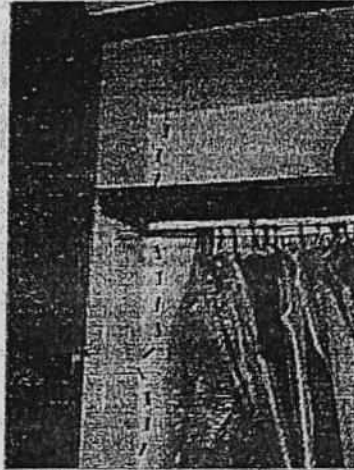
Estado actual de fisura en muro de chimenea apartamento 503 torre costado sur. (Fotografía tomada el 03 de agosto de 2021).
